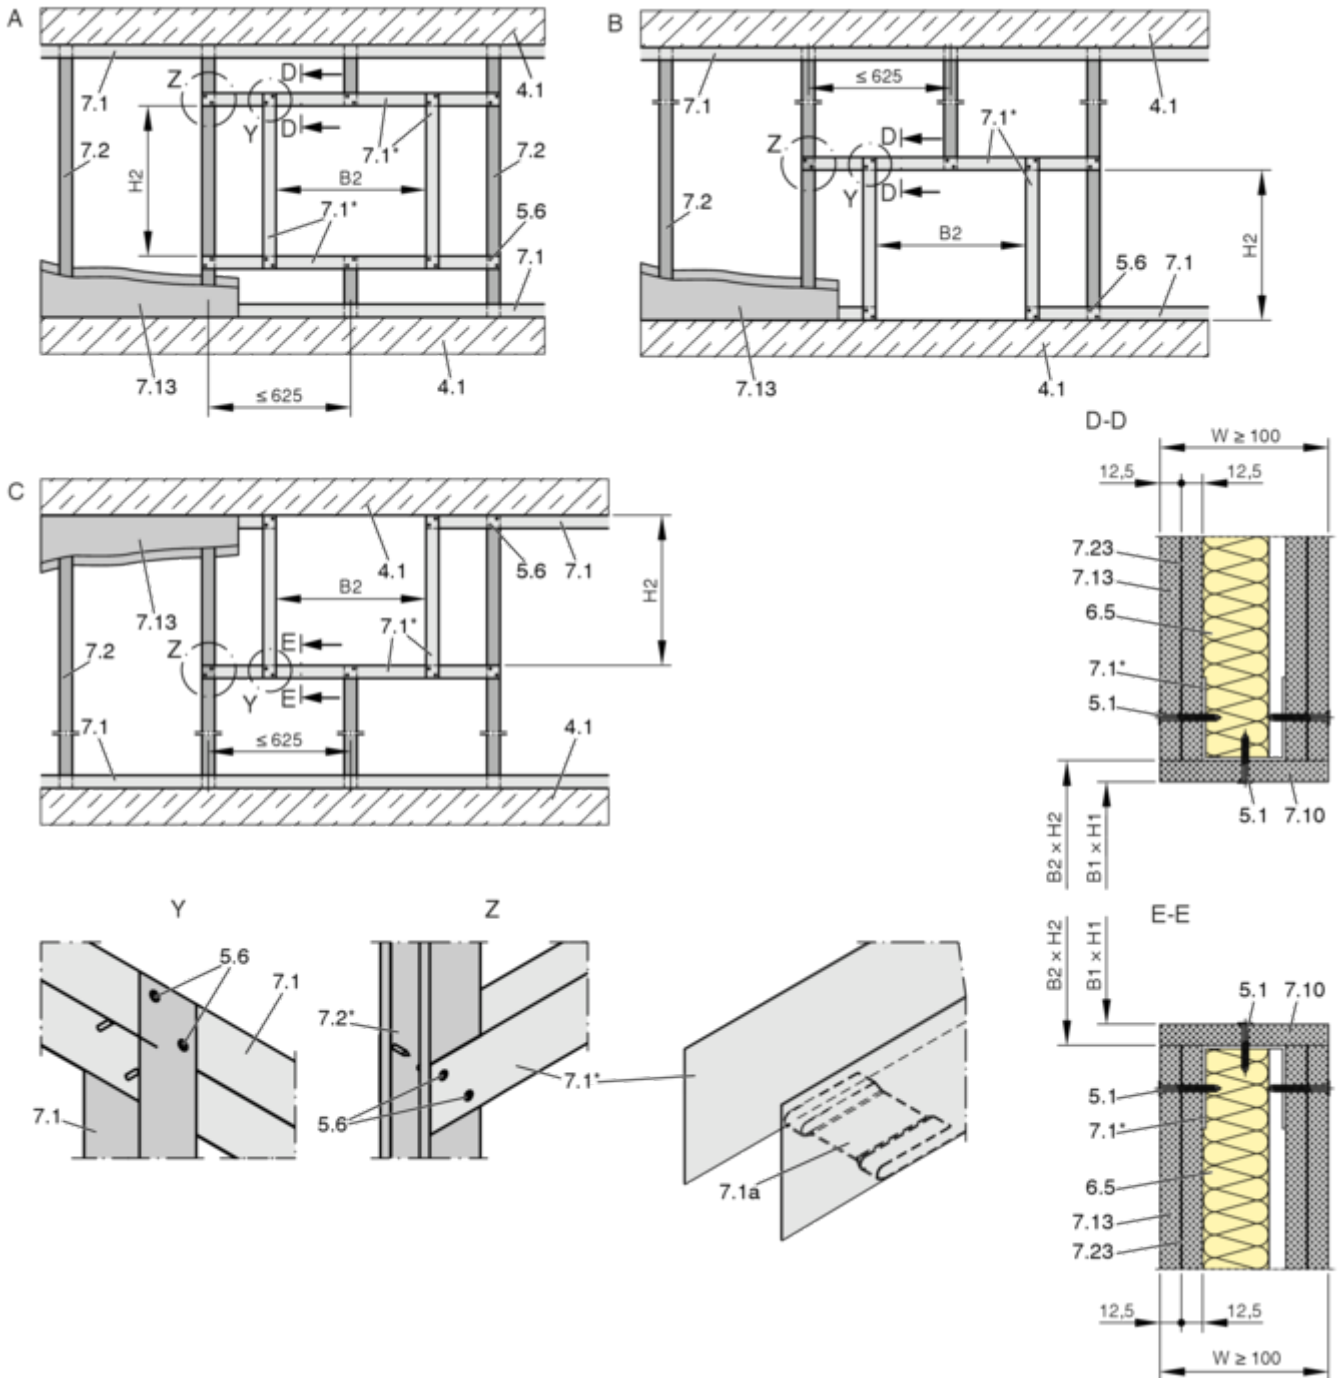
Leichtbauwand mit Metallständer und beidseitiger Beplankung, Bildlegende
